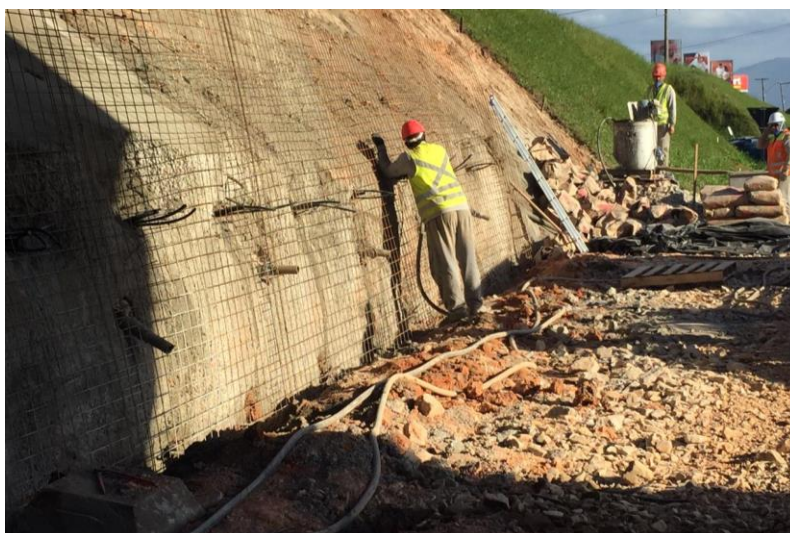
Serviços preliminares muro grampeado – Ramo 100.
